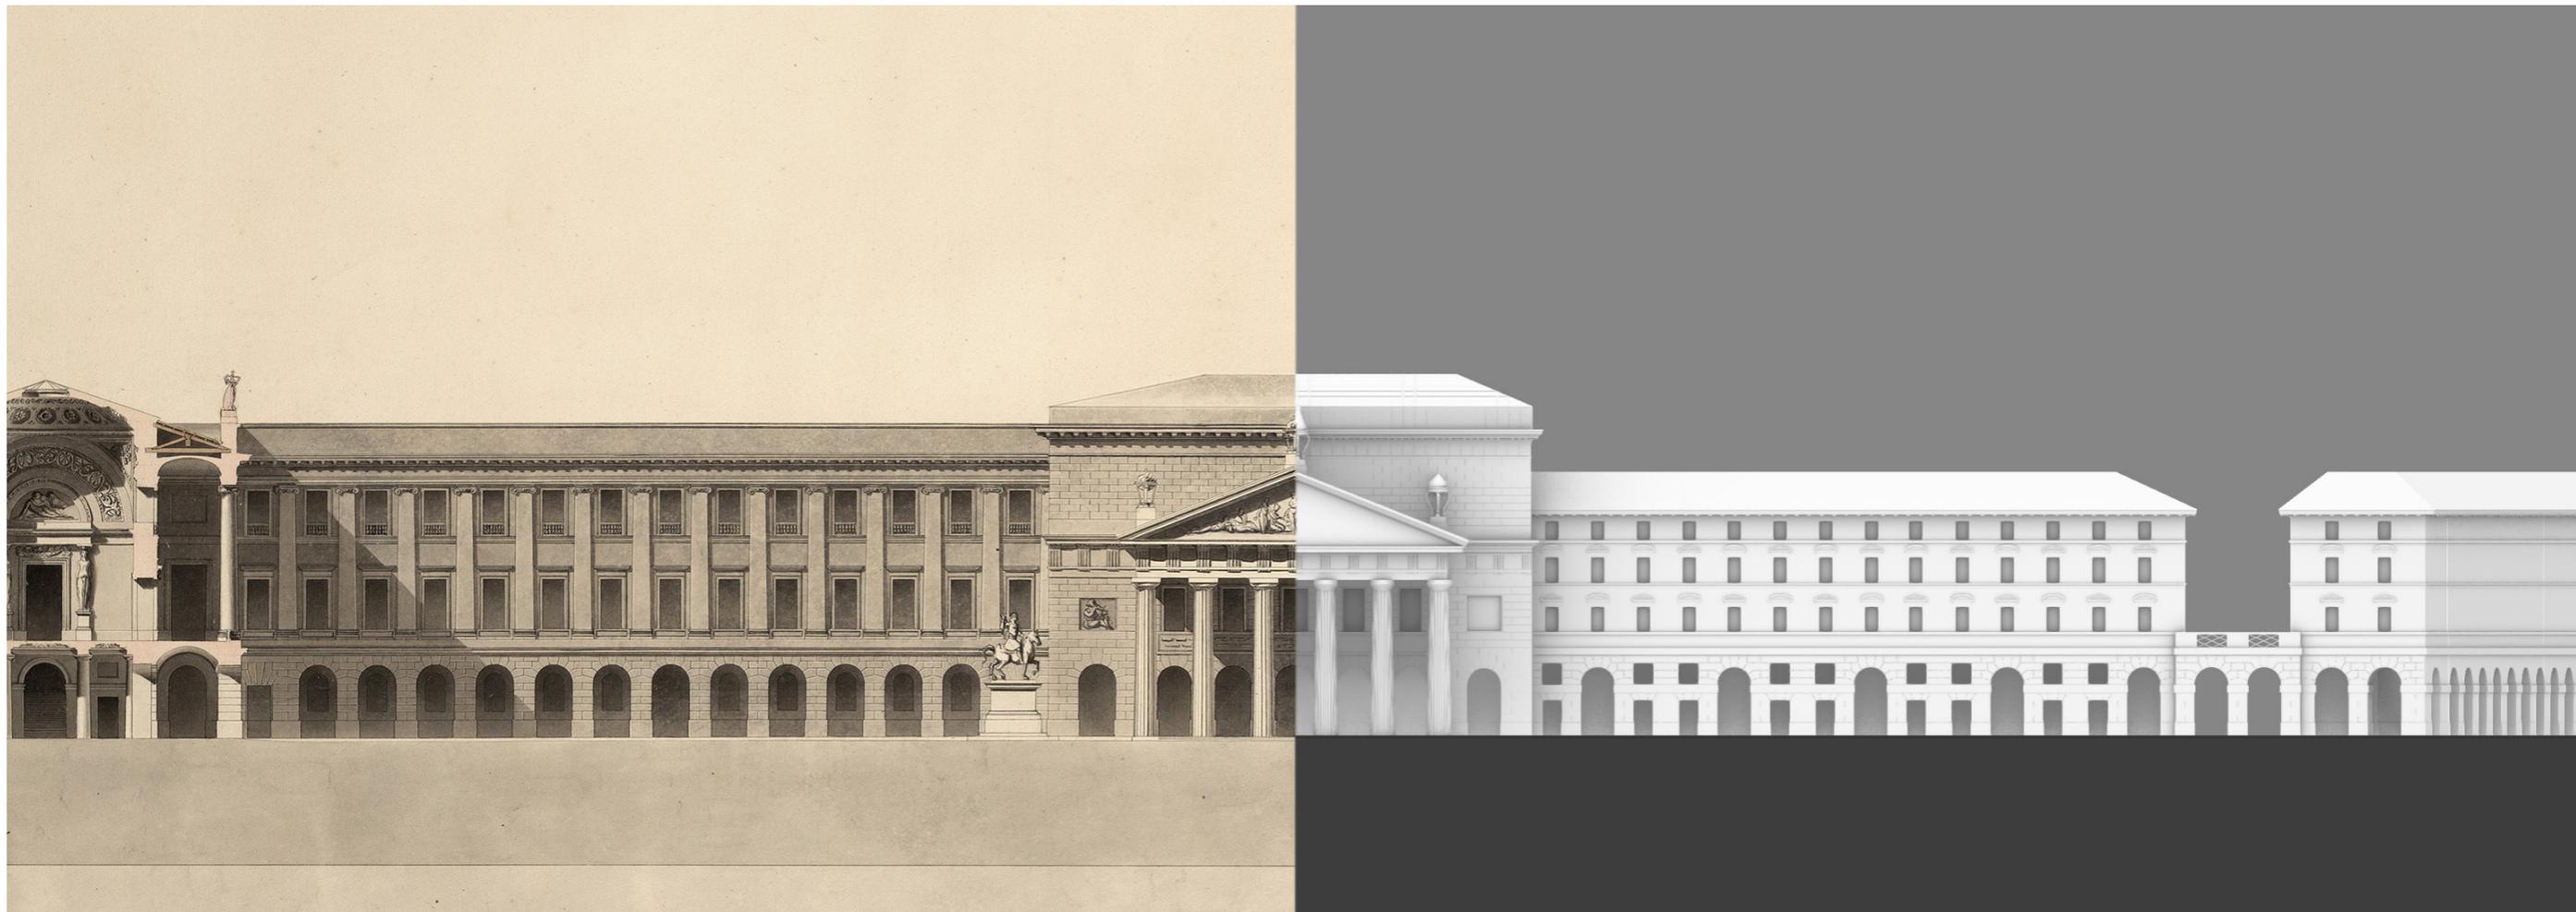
Confronto modello 3D - tavola originale del prospetto Est della Piazza Castello di Alessandro Antonelli
